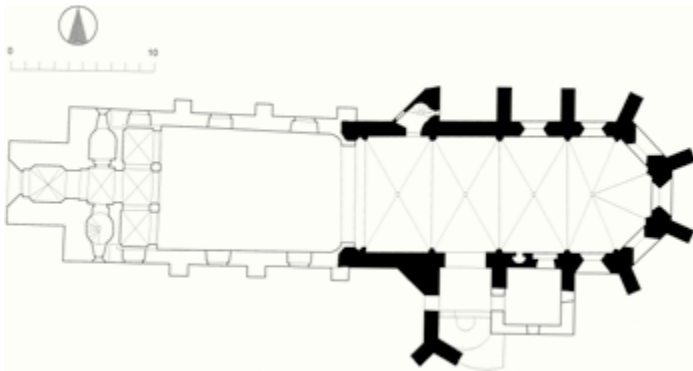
Pfarrkirche in Marchegg, Grundriss mit Hervorhebung des Chors
